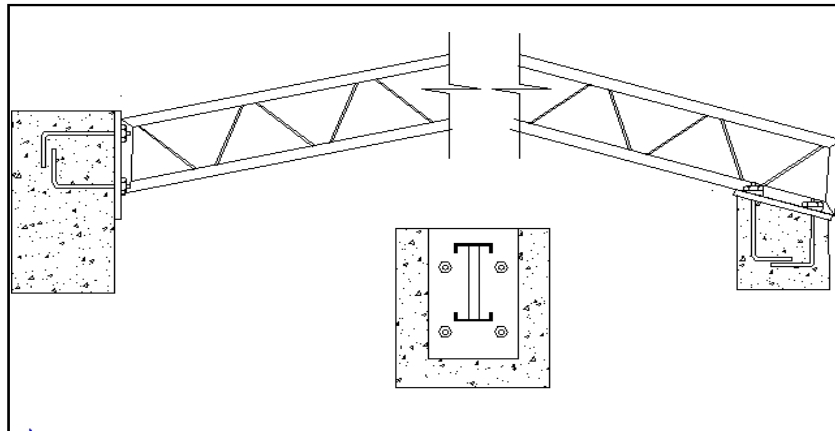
Apoyo de Viga de Techo por medio de Placa de Unión.
